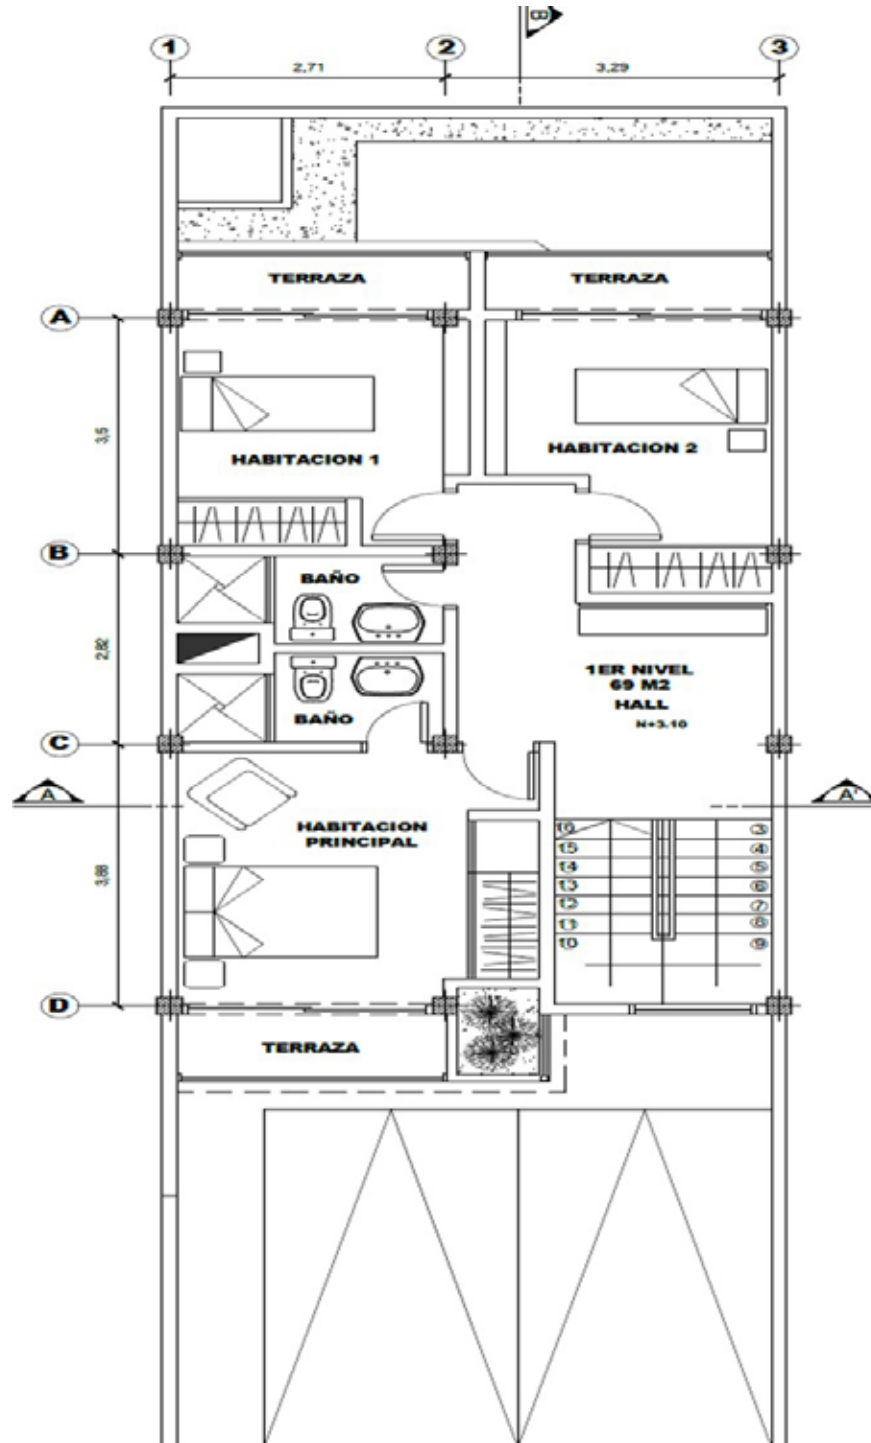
Plano Arquitectónico de Planta Alta Tipo.
